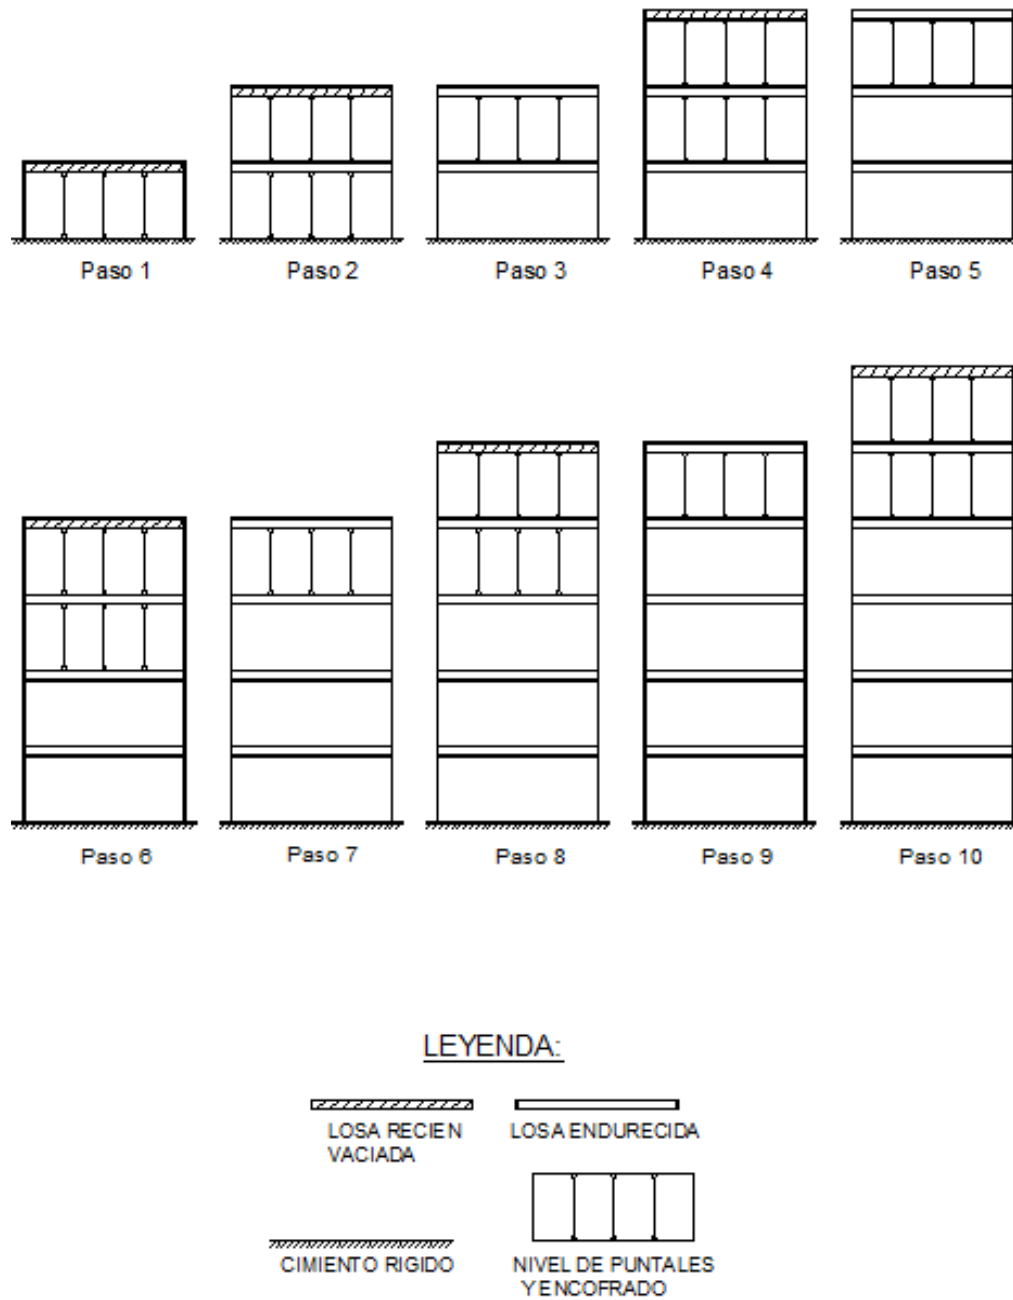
Sistema constructivo dos apuntalamientos (2S).
